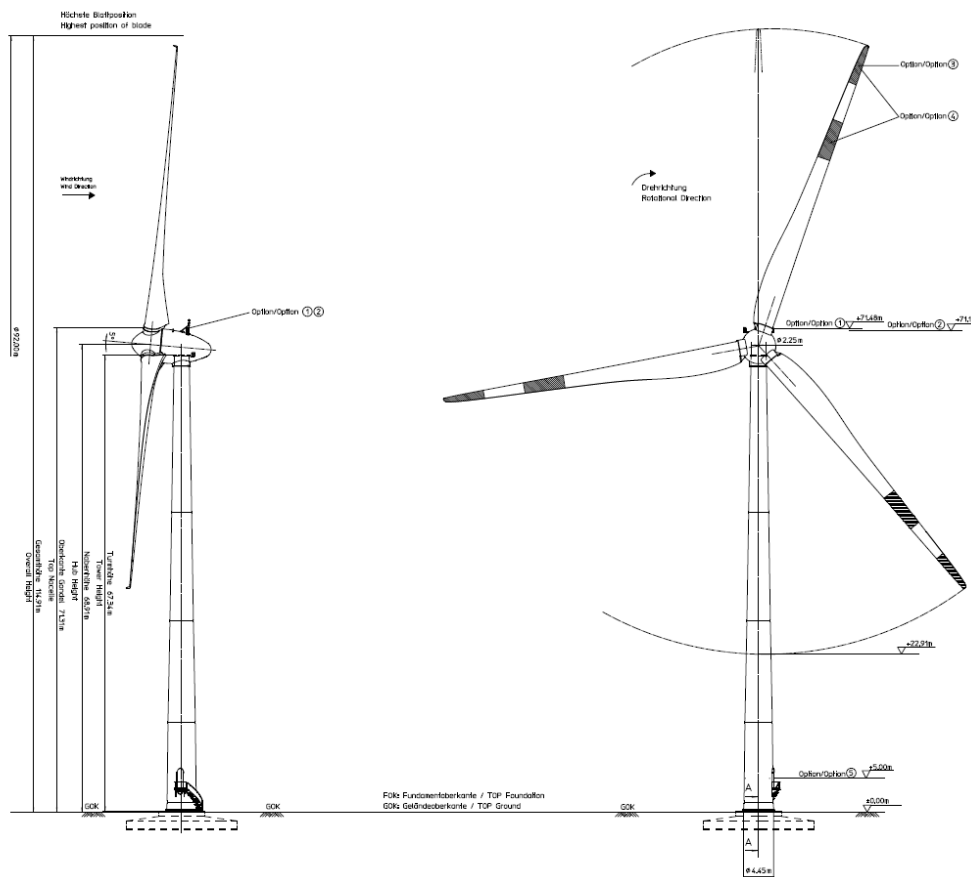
Plans en coupe de l'éolienne E92-2.35MW
